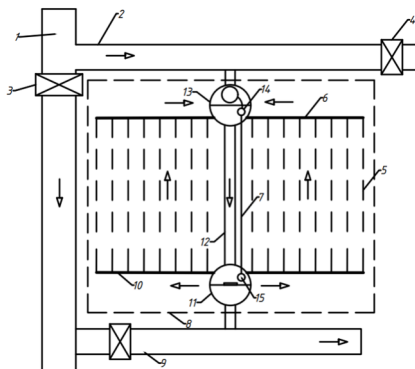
Схема одноблочної модульної автоматизованої осушувально-зволожувальної системи: 1 – магістральний канал; 2 – зволожувальний канал; 3 – головний підпірний шлюз; 4 – шлюз-регулятор; 5 – дрени; 6 – аераційний колектор; 7 – закритий гідравлічний зв'язок; 8 – границя модуля; 9 – осушувальний канал; 10 – дренажний колектор; 11 – скидний колодезь; 12 – осушувально-зволожувальний колектор; 13 – водоприймальний колодезь; 14 – датчик-прискорювач; 15 – датчик рівня
